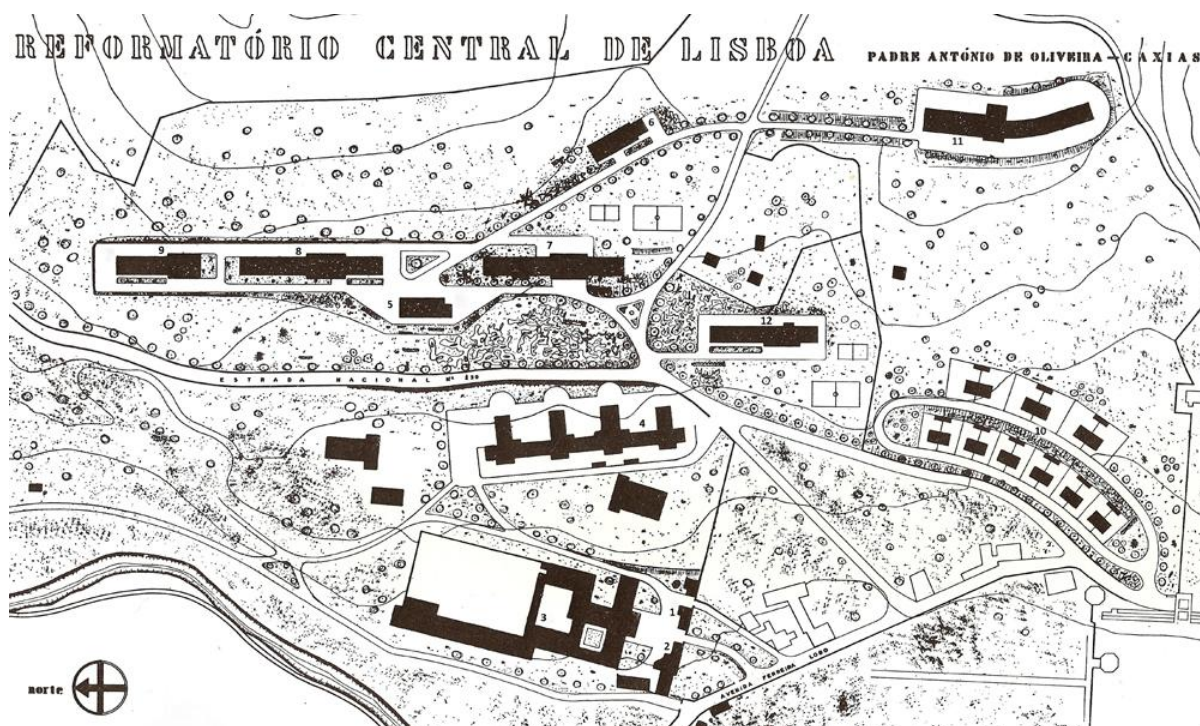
Planta geral das instalações pré-existentes e as propostas (1949)
